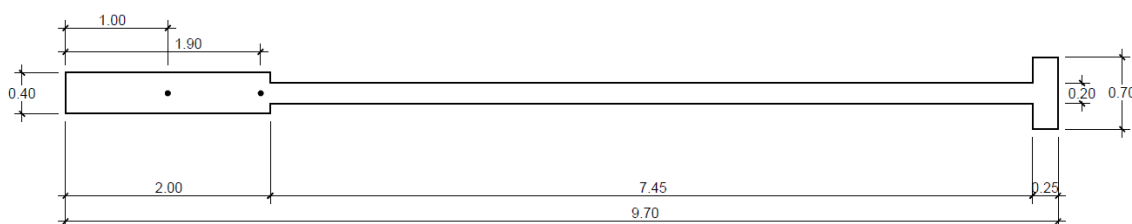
Segundo modelo geométrico para el diseño de la placa
